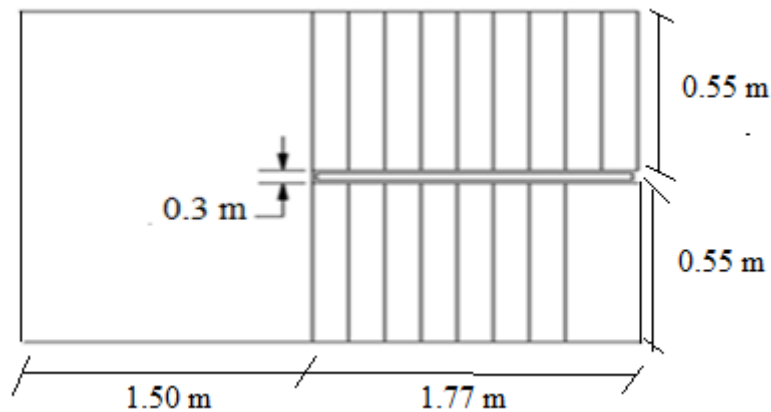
Vue en plan de l'escalier tirée du plan d'architecture.
